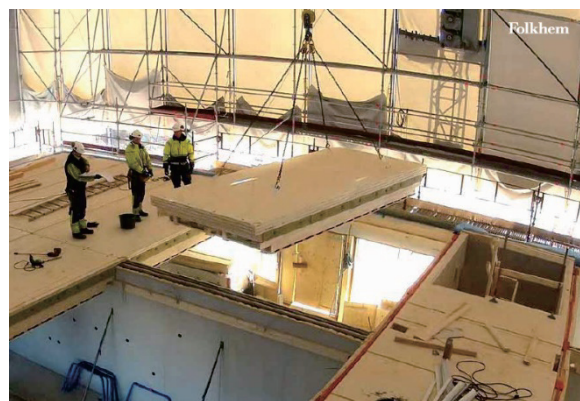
床CLT施工の様子(Folkhem受領資料より)
